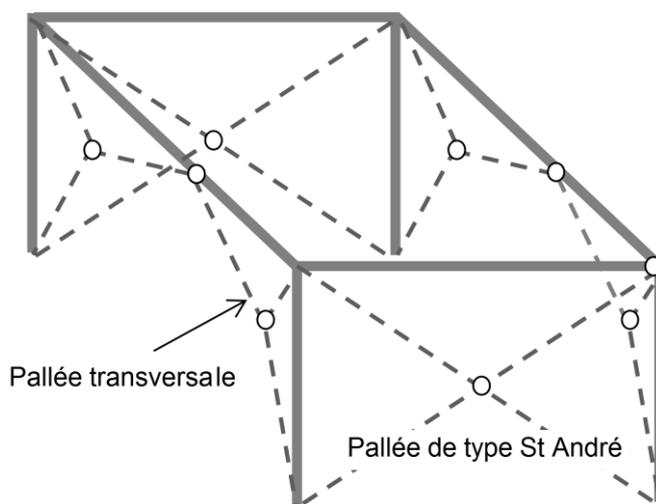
exemple de l'ajout d'un contreventement métallique
